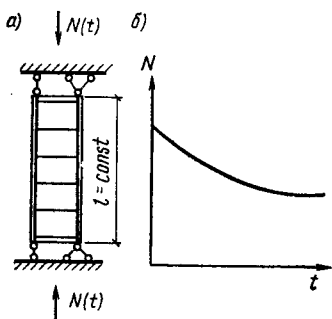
Релаксация напряжений в бетоне при постоянных напряжениях в арматуре железобетонной призмы
